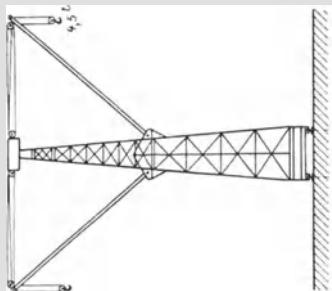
a u. b. Hellingausrüstung. Auslegerkräne. Maßstab 1:800.
